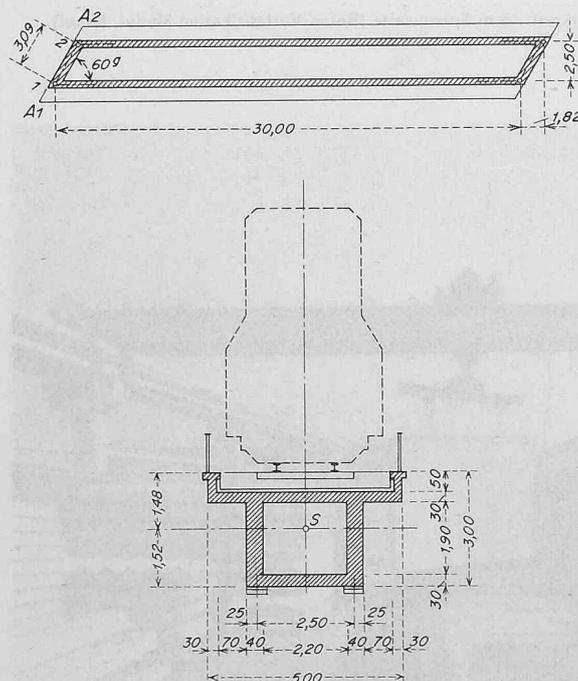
Abmessungen der Eisenbahnbrücke im Grundriss und Querschnitt
